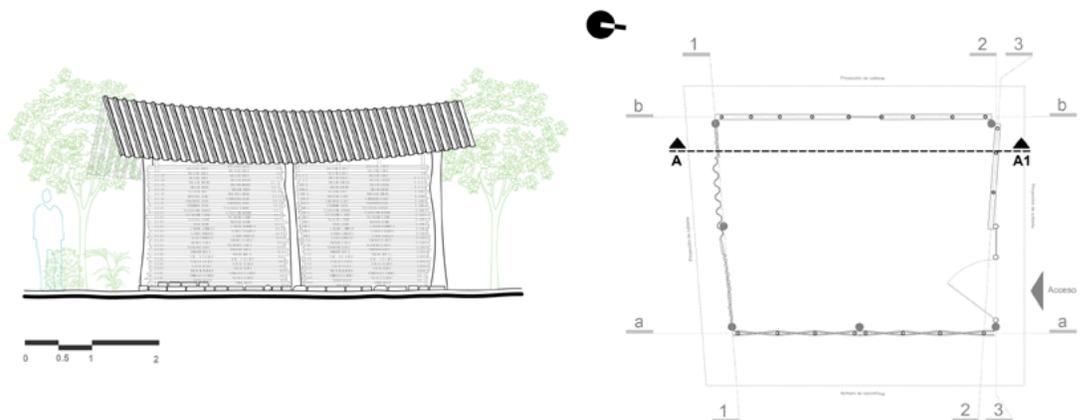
Alzado y plano arquitectónico de un módulo de vivienda de pajarete ubicado en la zona Valle del estado de Colima (Dibujos: Antonio Flores, 2017).
